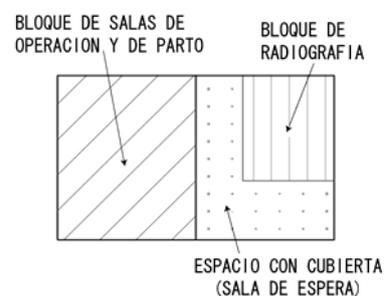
Plan de Planta del Pabellón de Ampliación del Hospital Departamental
